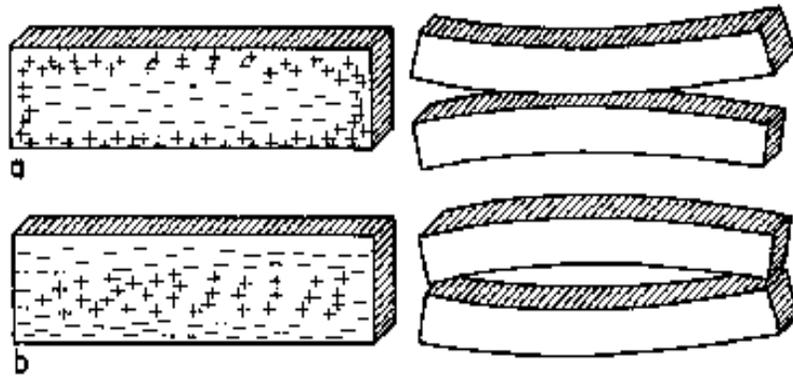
Condición de esfuerzo durante el secado de la madera que conduce al defecto de endurecimiento:
